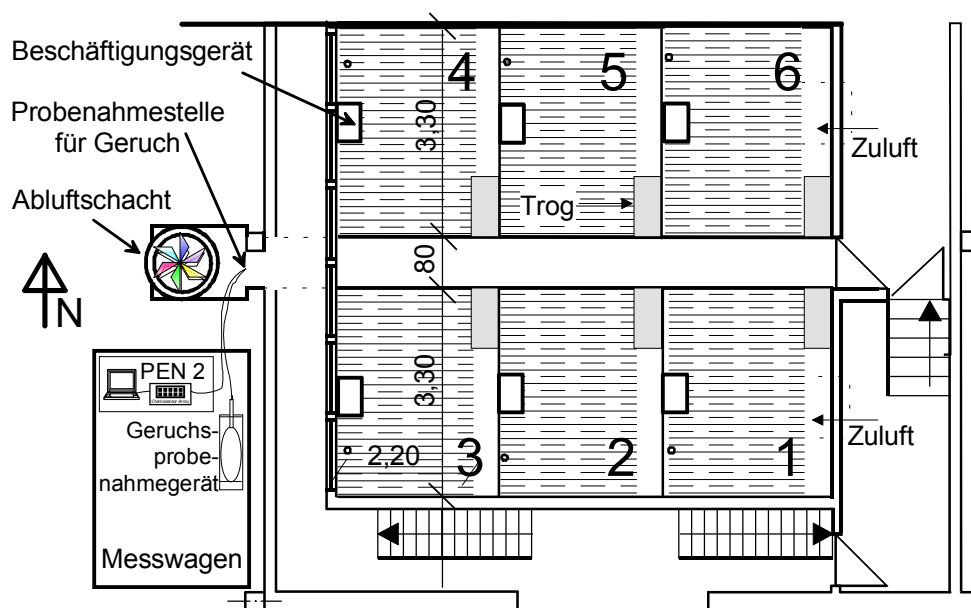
Grundriss des untersuchten Mastschweineabteils
